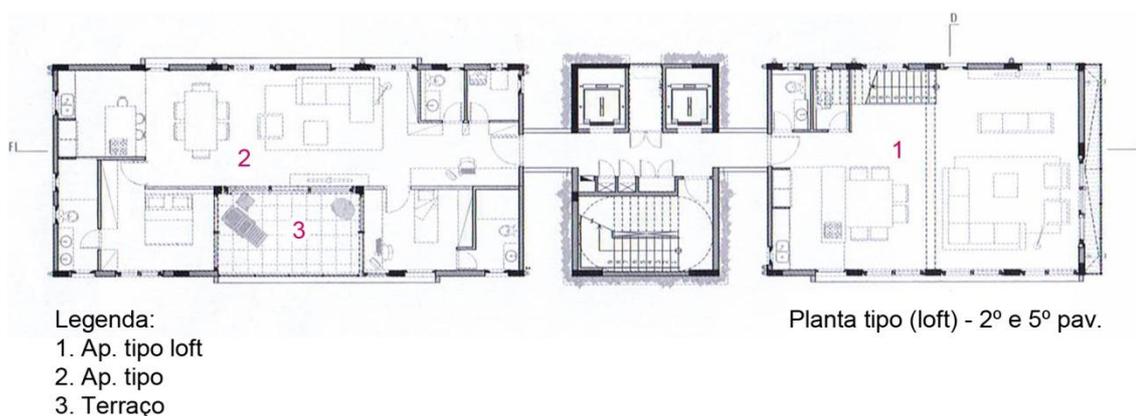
PLANTA TIPO – 2º E 5º PAVIMENTO
